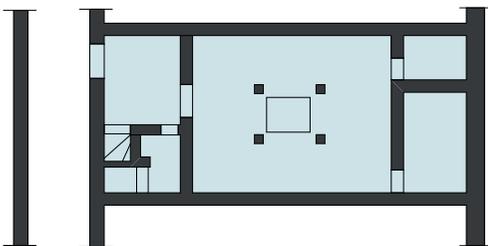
Grundriss Aït-Ben-Haddou
